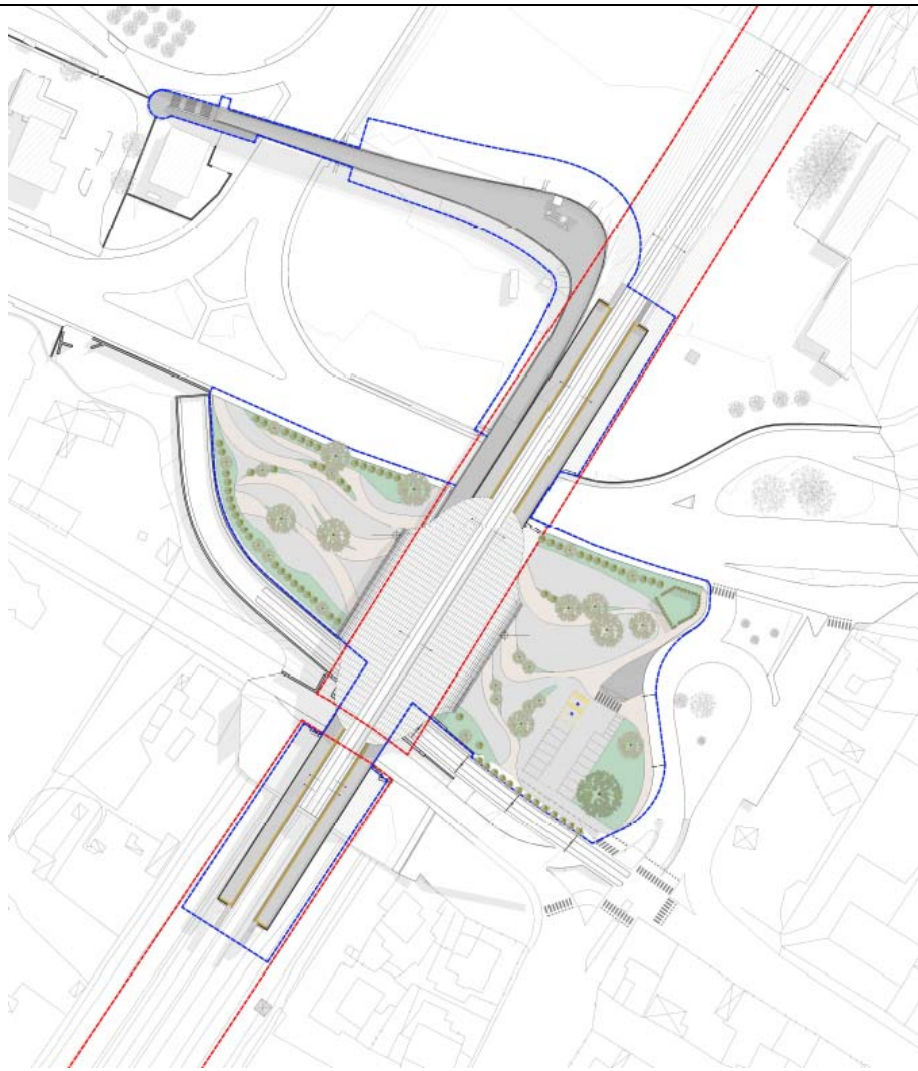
Stralcio della planimetria generale e la sistemazione a verde
